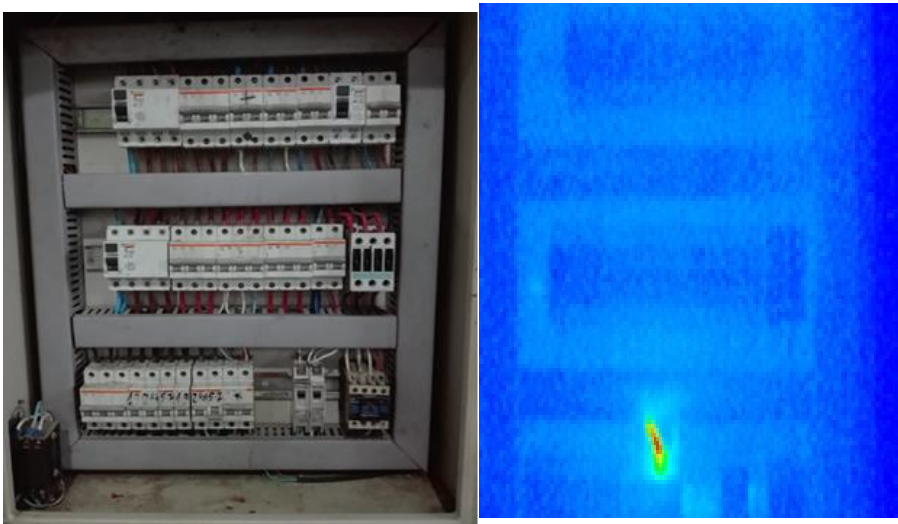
Tablero General de Baja Tensión (T.G.B.T.)
